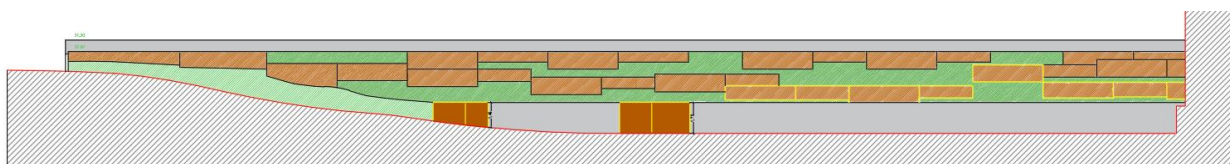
Pormenor de projeto para faseamento do talude através de chapas metálicas.
